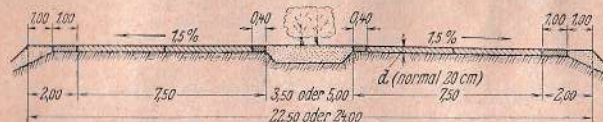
Querschnitt einer Reichsautobahn mit Betonfahrbahn.
